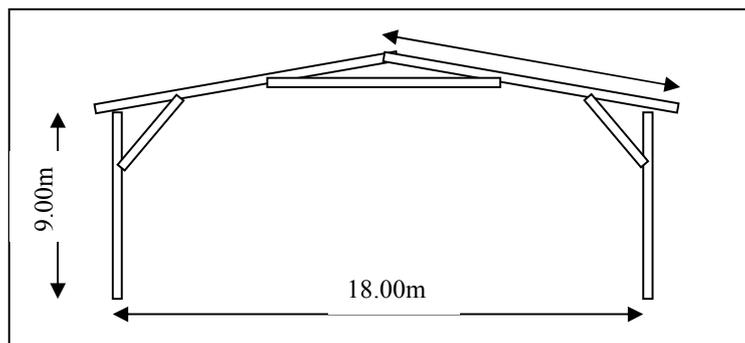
b. Estructura de pórtico propuesto de 18 m de luz
